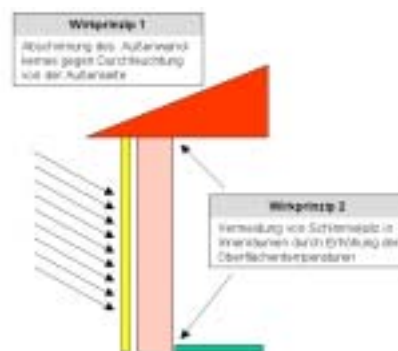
Erhalt der Bausubstanz durch zweifaches Wirkprinzip von vorgehängten Holzfassaden
